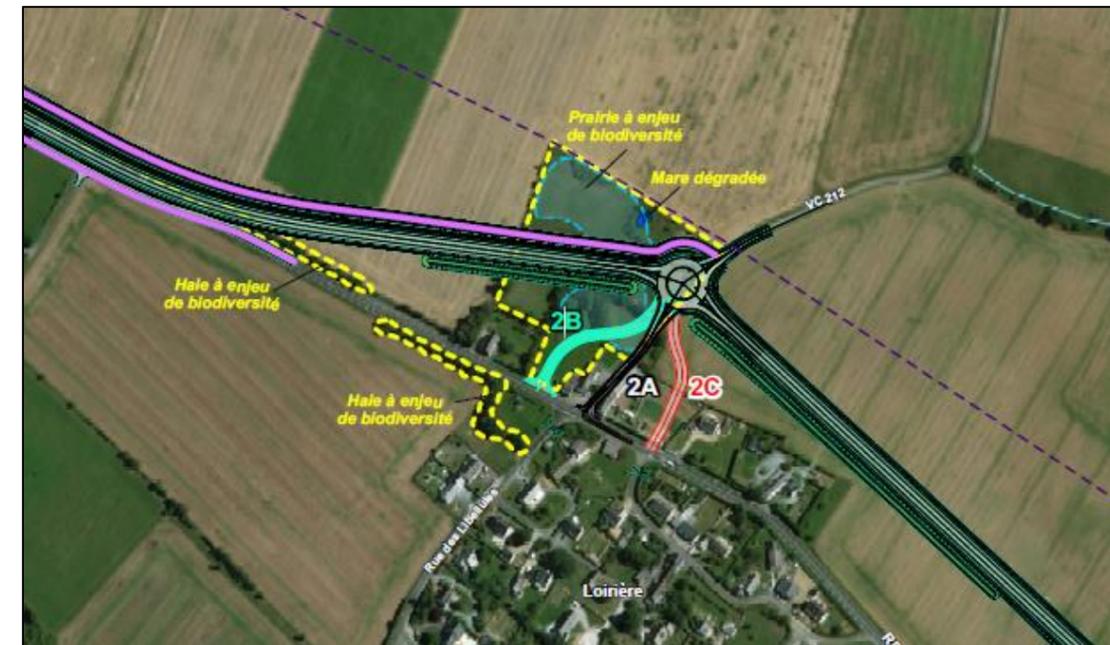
Plan de la variante 2 (carrefour giratoire intermédiaire)
